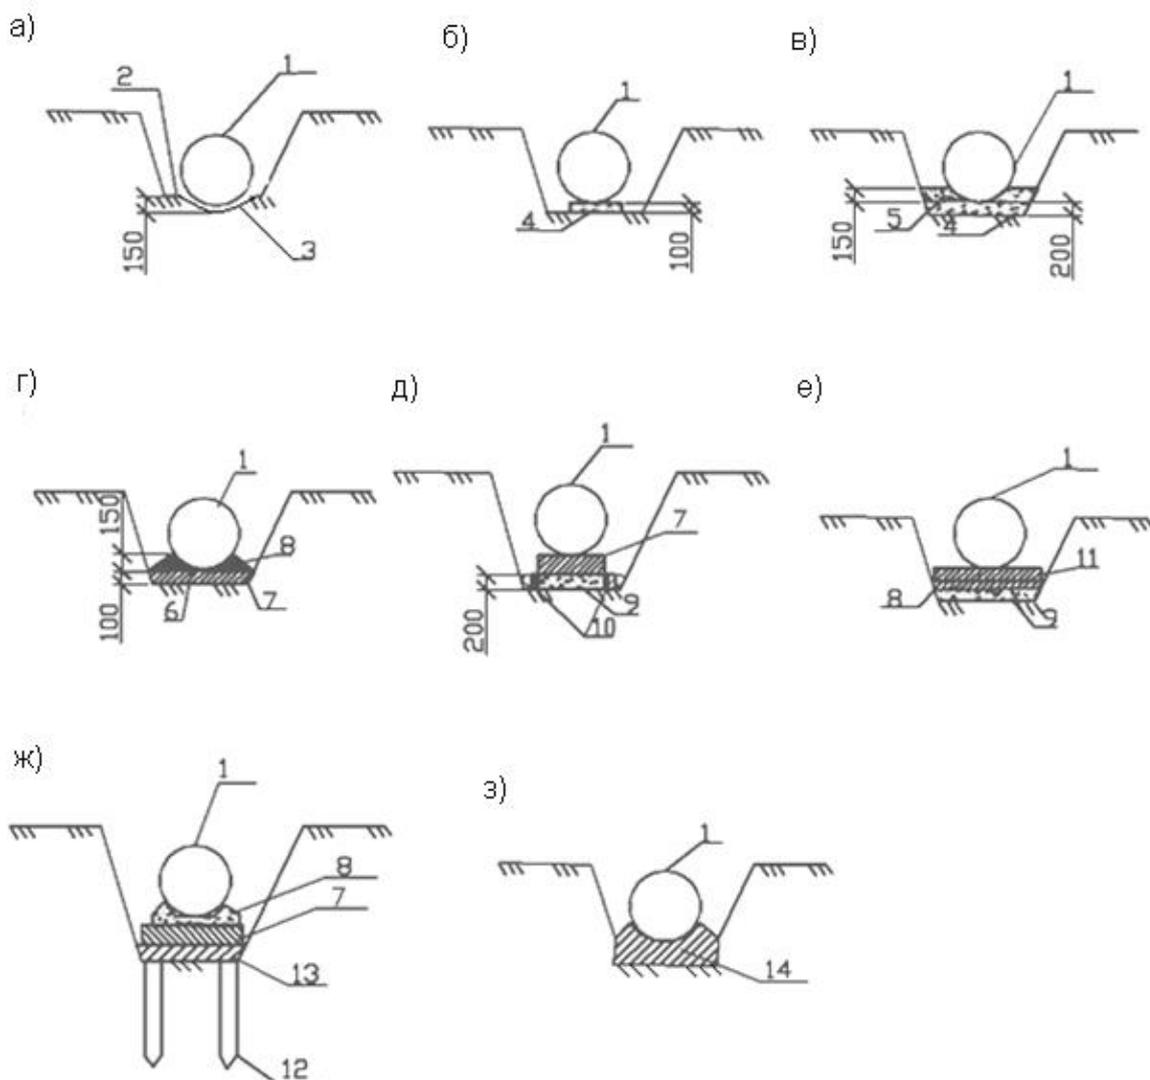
Типы искусственных оснований под трубопроводы:
